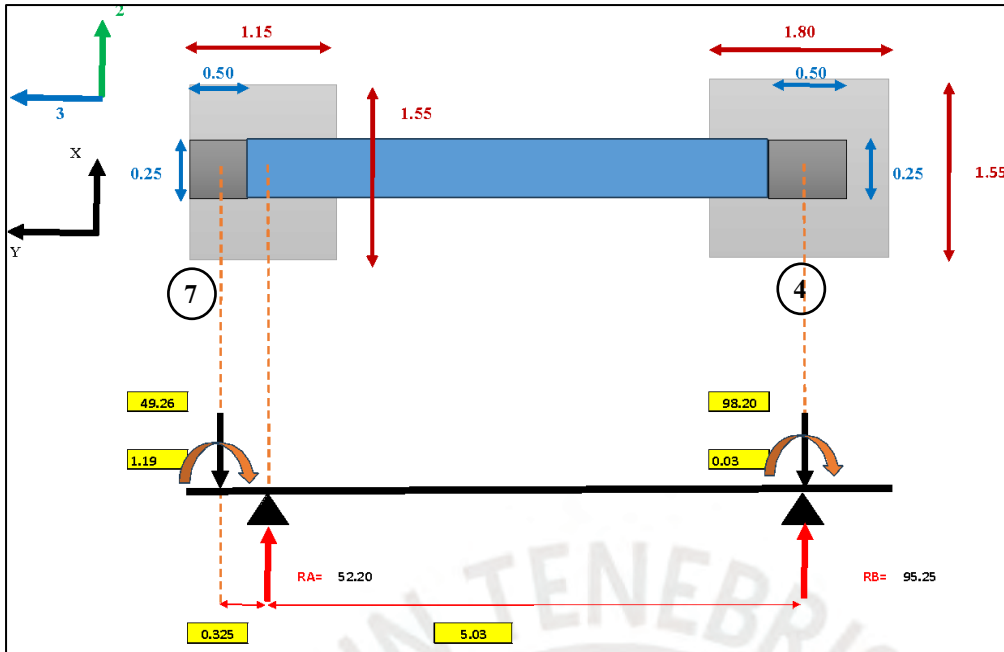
Esquema de cargas actuantes en la viga de cimentación
